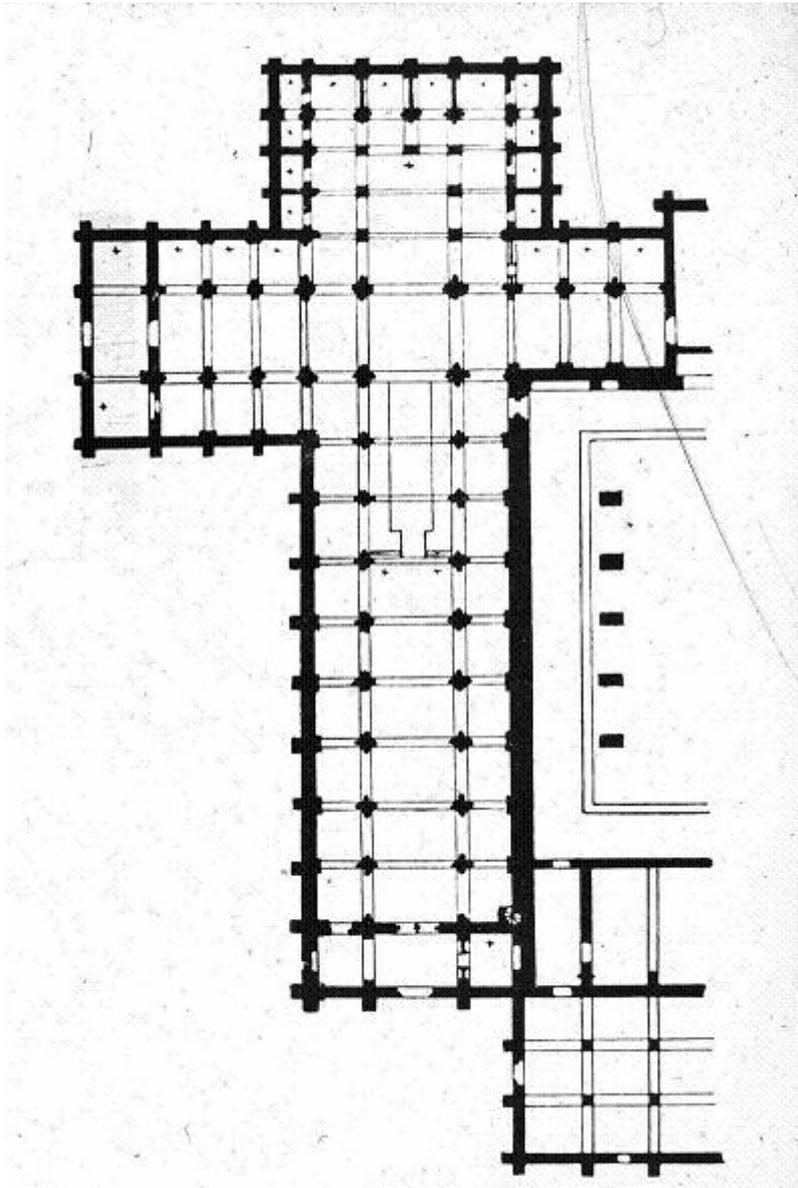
Cîteaux, Abteikirche Cîteaux III (Weihe 1193), Grundriss
